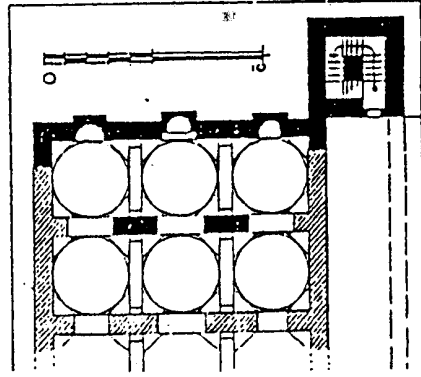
مسقط أفقي لمسجد ترمذ (عن ، Hillenbrand)
